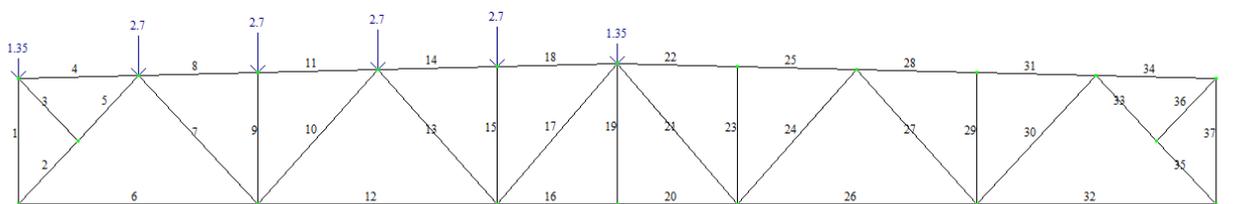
Загрузка 4 (снеговая нагрузка на половину пролета фермы)
